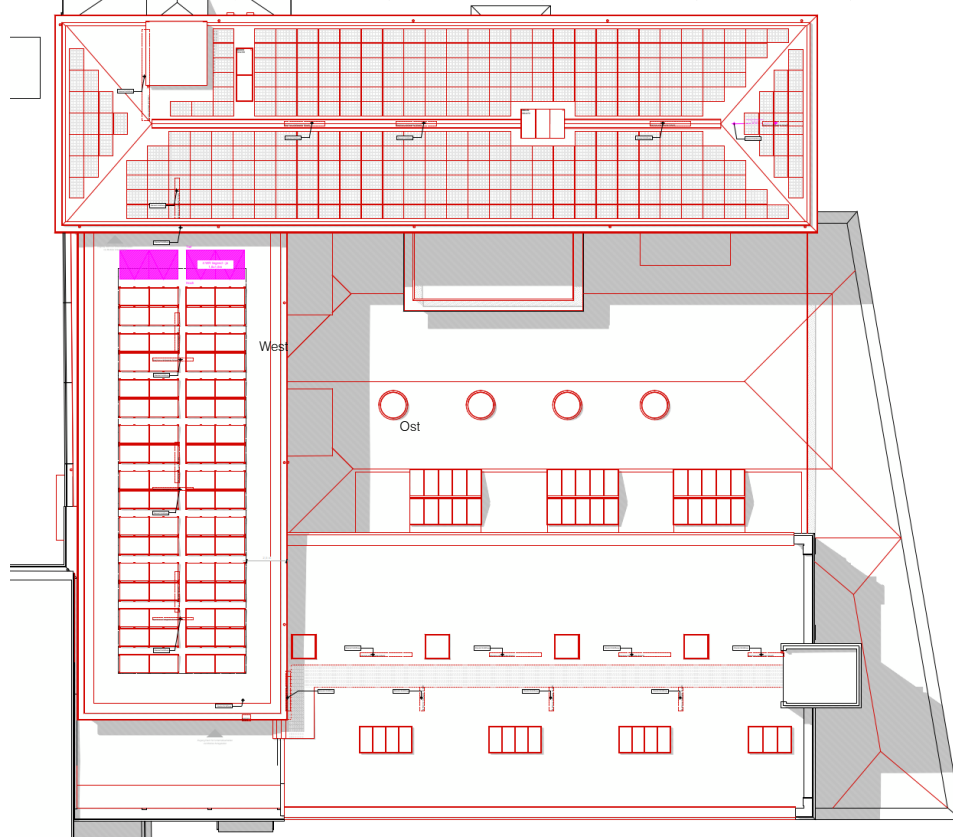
Belegungsplan, Modul layout WR Standort (pink)
